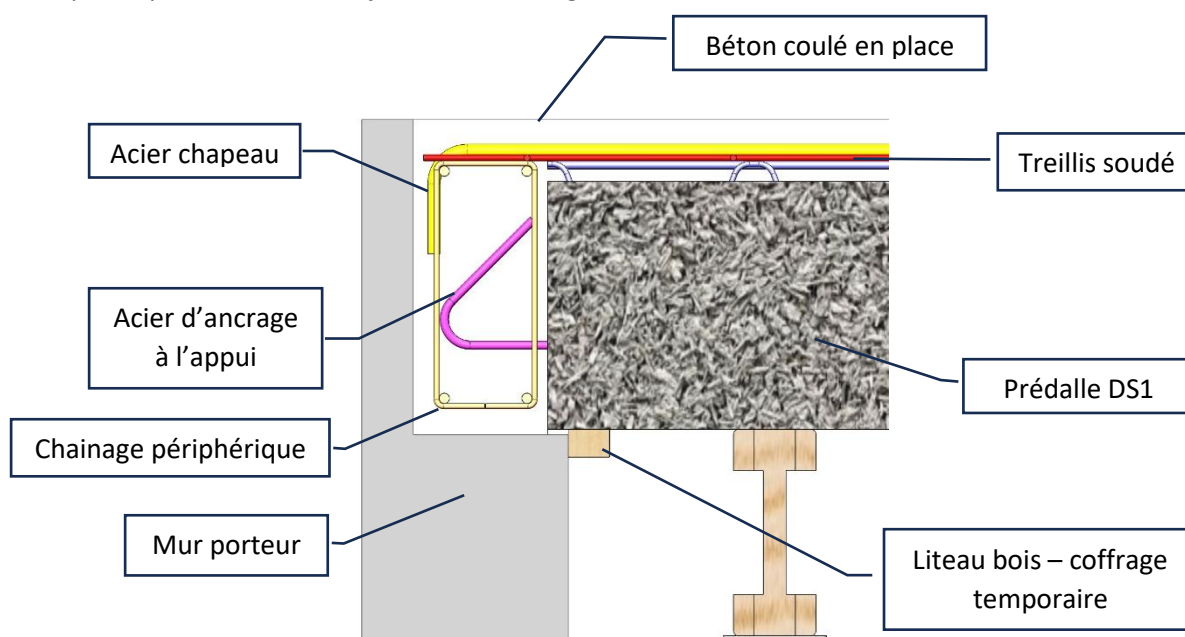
Coffrage d'un jeu vertical trop important avant coulage du béton armé
